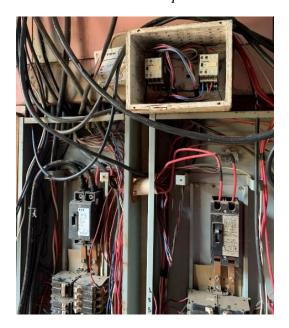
"Estado de paneles en pabellón 11". Fuente: Elaboración Propia.
